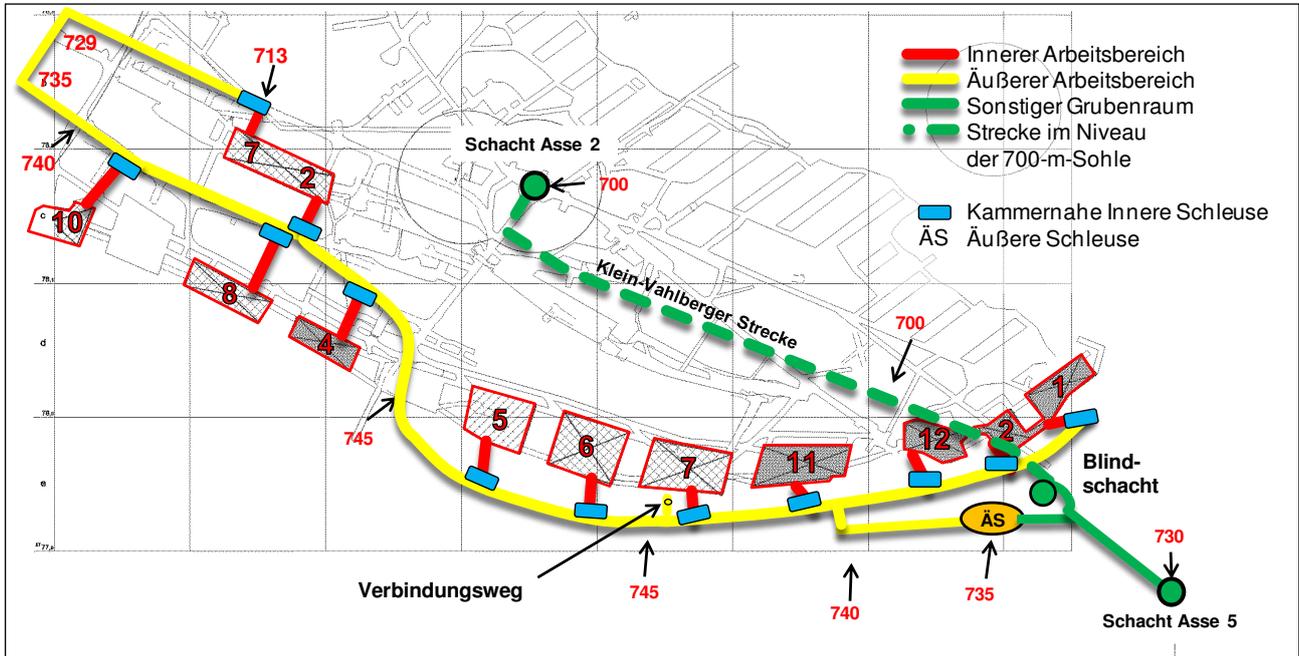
Schematische Darstellung der Variante 6 – Rückholung von Süden – mit kammernahen Inneren Schleusen und Blindschacht (Hintergrund: Grundriss der 750-m-Sohle)
